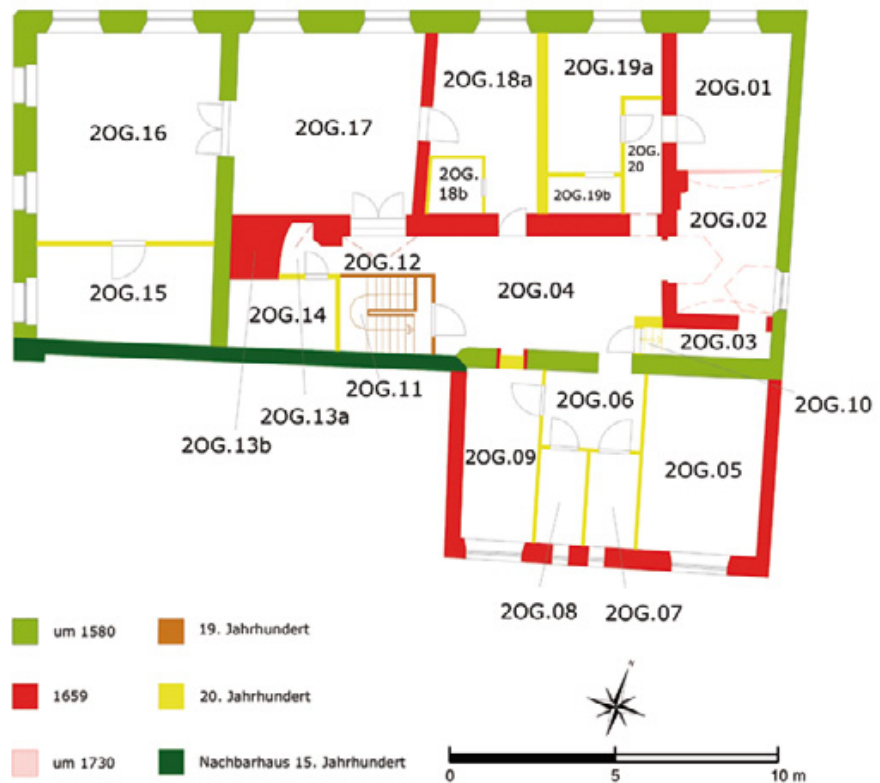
Krems, Untere Landstraße Nr. 2, Bürgerhaus. Baualterplan des 2. Obergeschoßes.
